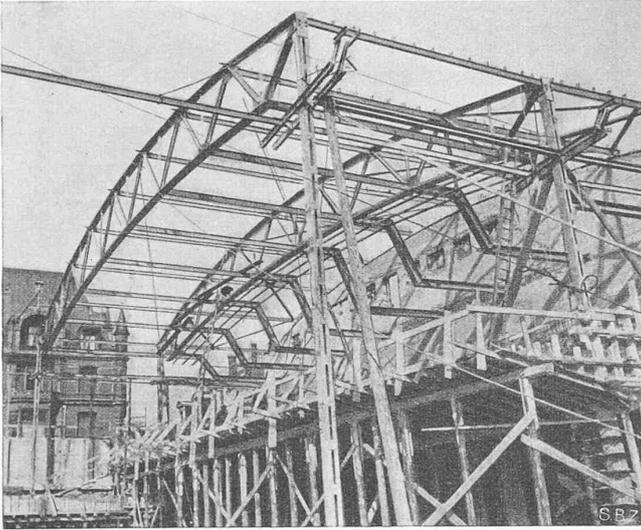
Montage der eisernen, nachher einbetonierten Säulen und der Dachkonstruktion des Kongress-Saals; Schalung der Hauptgalerie
